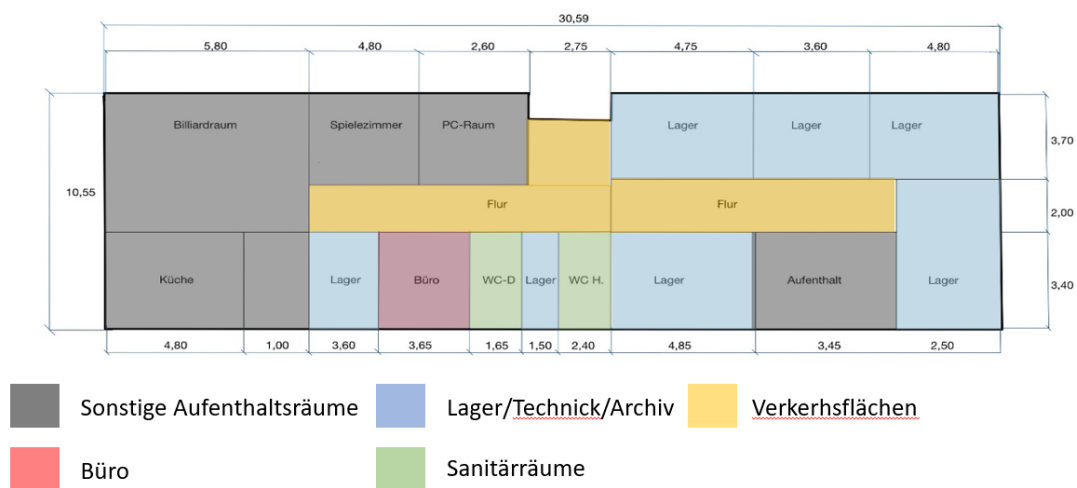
Zonierter Grundriss des untersuchten Gebäudes
